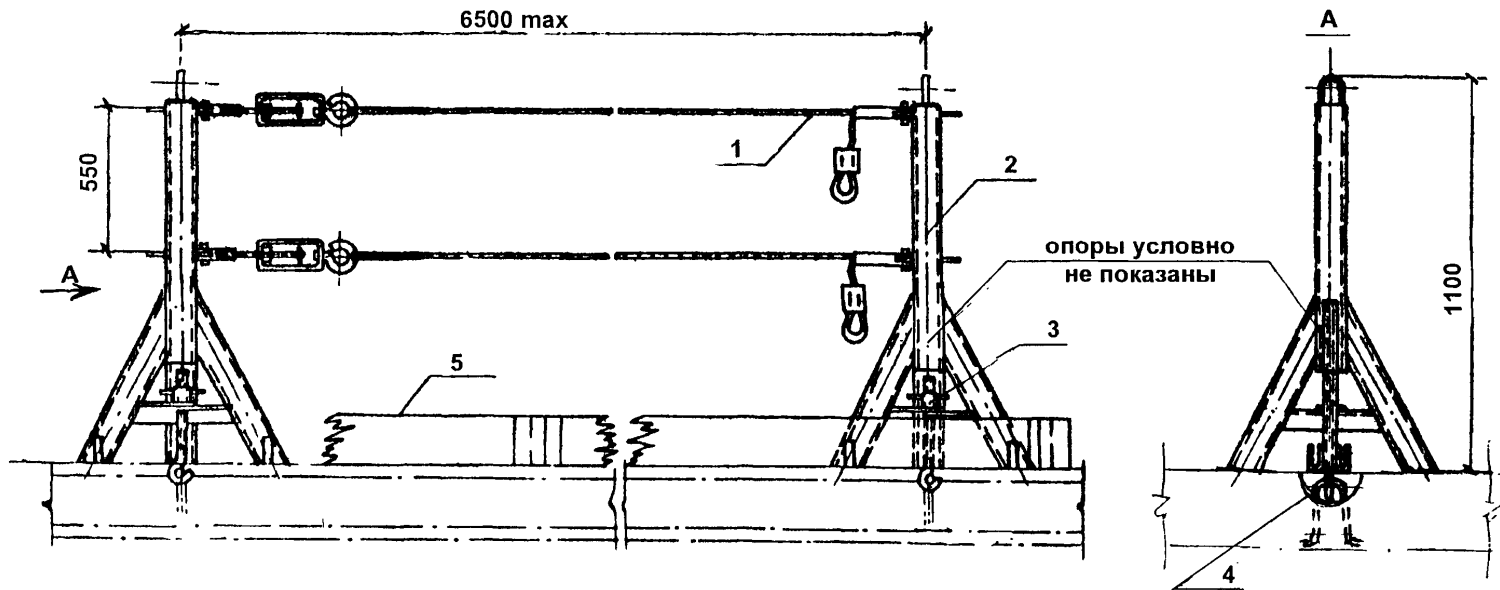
Универсальное временное ограждение опасных зон на перекрытии (тросиковое):
